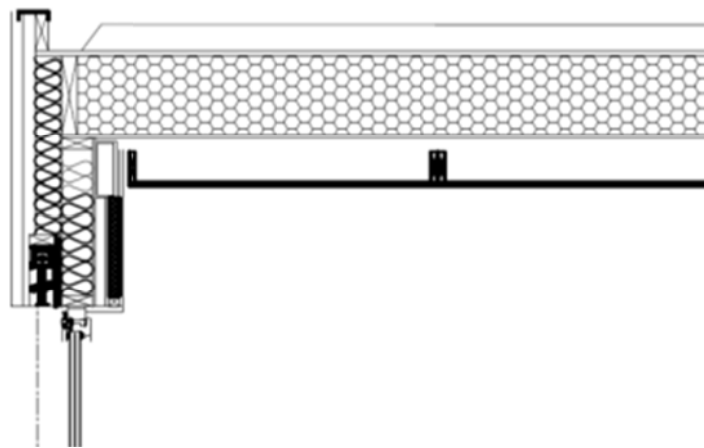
Sección encuentro fachada con cubierta. Fuente: AMP_CD_2010-09-22
